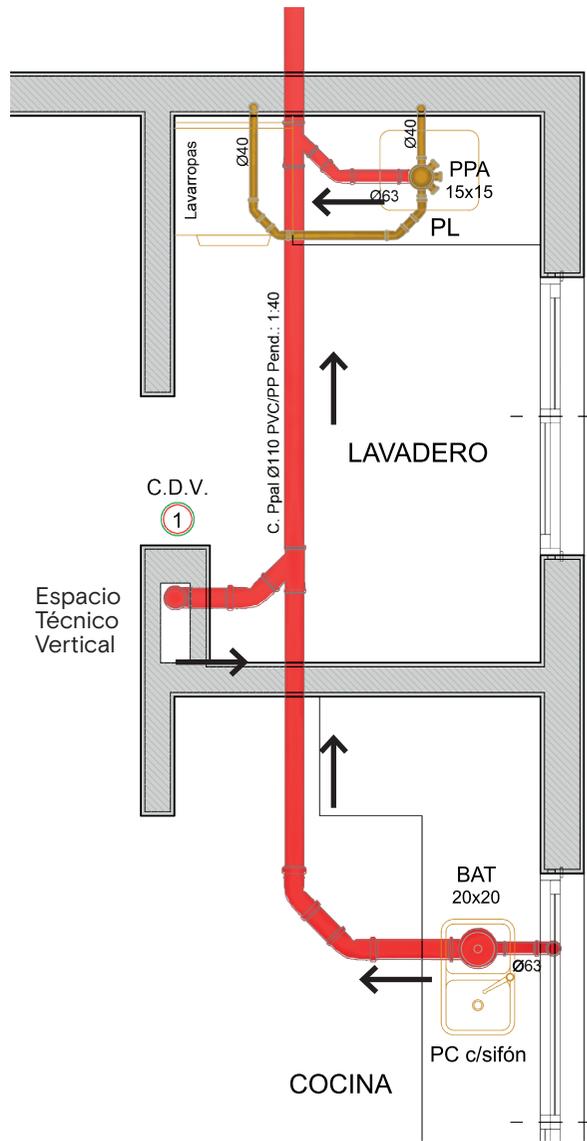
Detalle de desague de Pileta de cocina y lavadero en planta baja.
